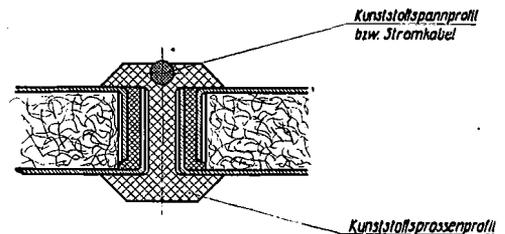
Wandplatte aus Stahlblech, Montage mit Sprossenprofil
